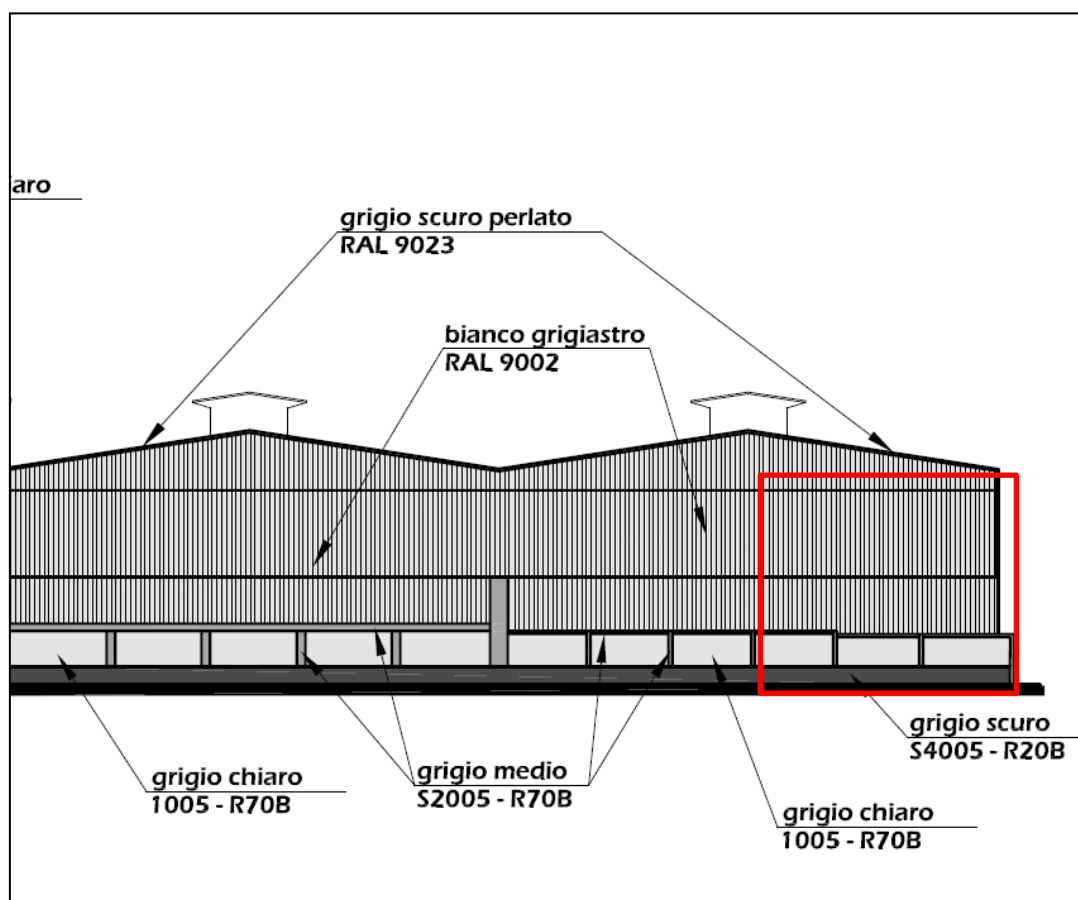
Facciata di Fincantieri interessata dall'intervento
